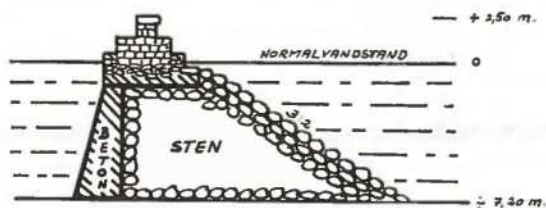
BETON-BØLGEBRUDER. (1:200)
